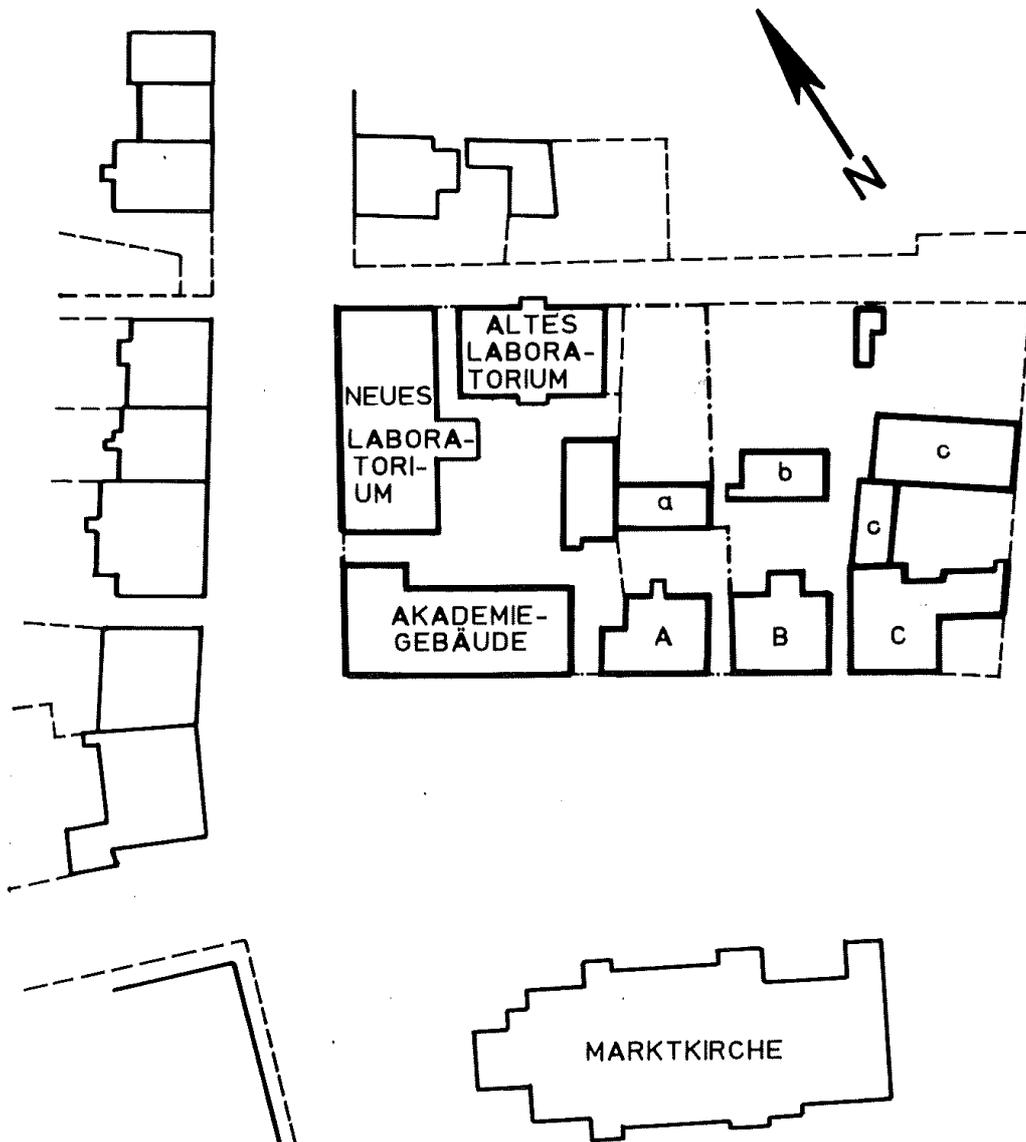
Lageplan der Gebäude und Grundstücke im Geviert des heutigen Hauptgebäude-Komplexes nach dem Stand von 1890;
